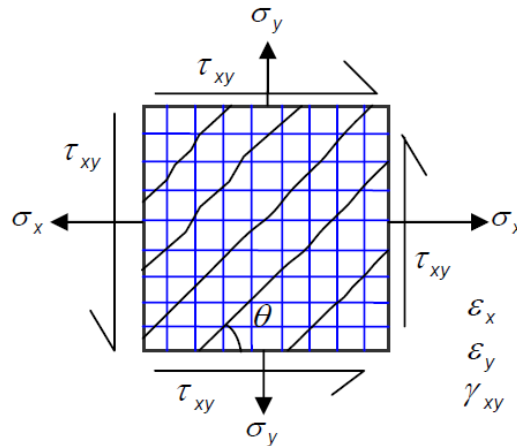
Elemento 2D de hormigón armado fisurado [88].
